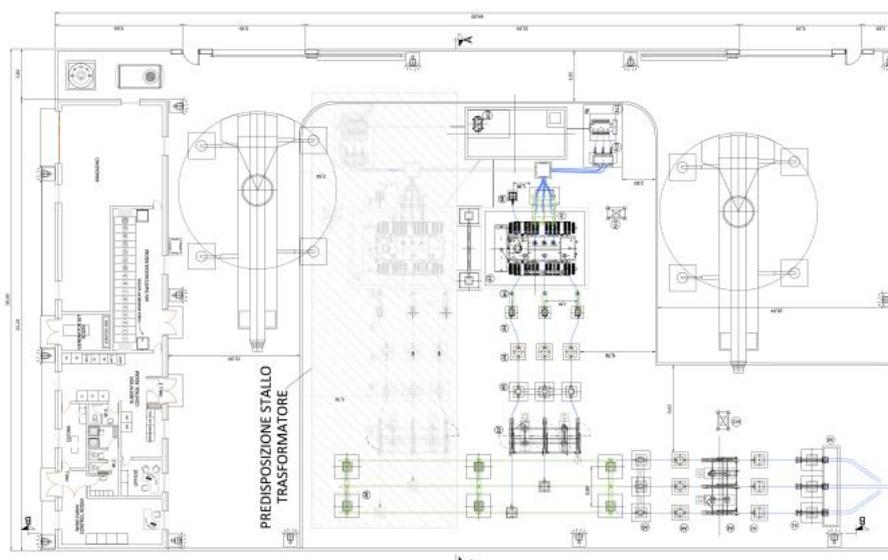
Esempio di schema planimetrico della Sottostazione di misura e consegna
